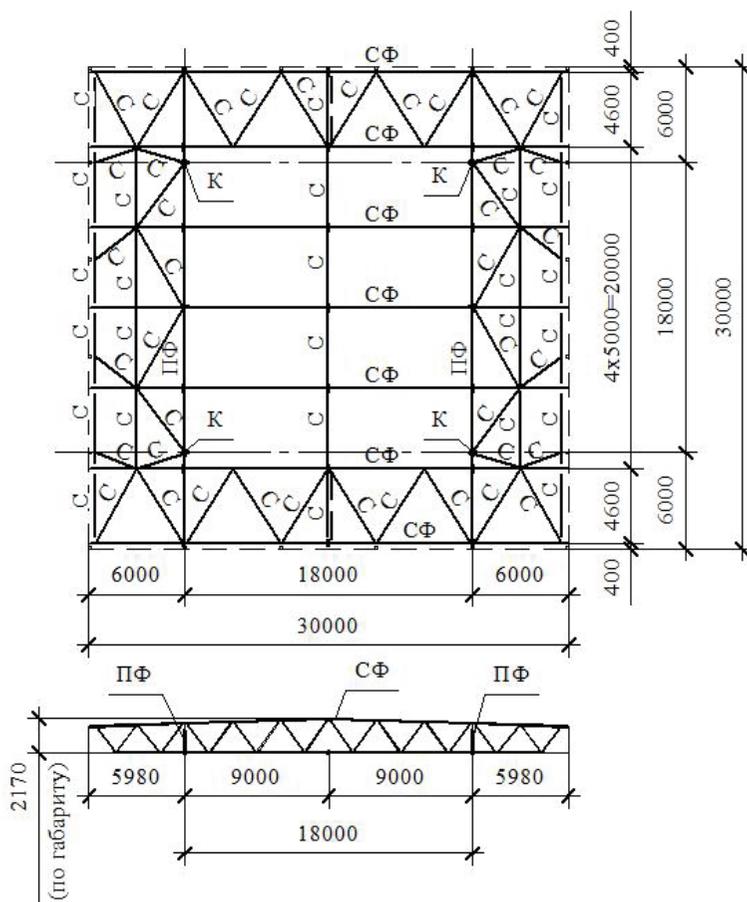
Схема покрытия со стропильными и подстропильными фермами (Вариант 4)
